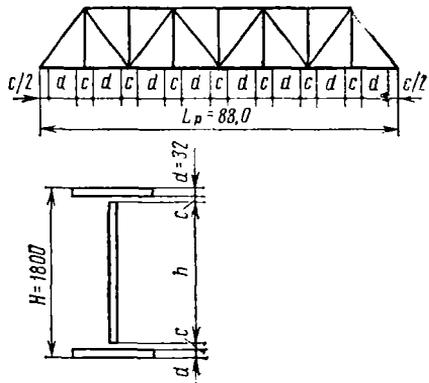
Схемы к расчету допускаемых отклонений размеров
